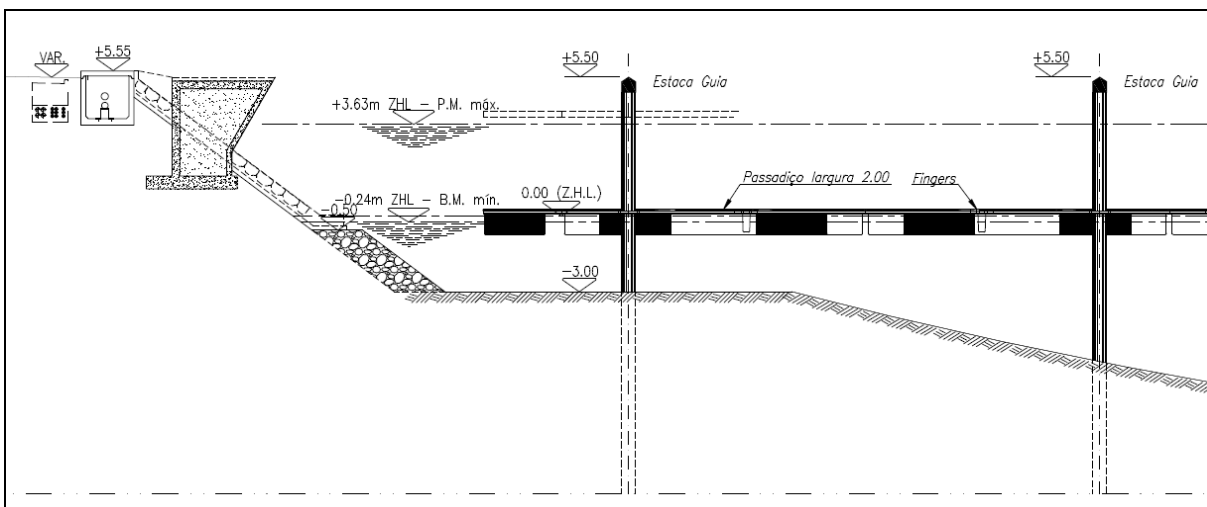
Corte dos passadiços e acesso ao Porto de Recreio (imagem do projecto de execução).
